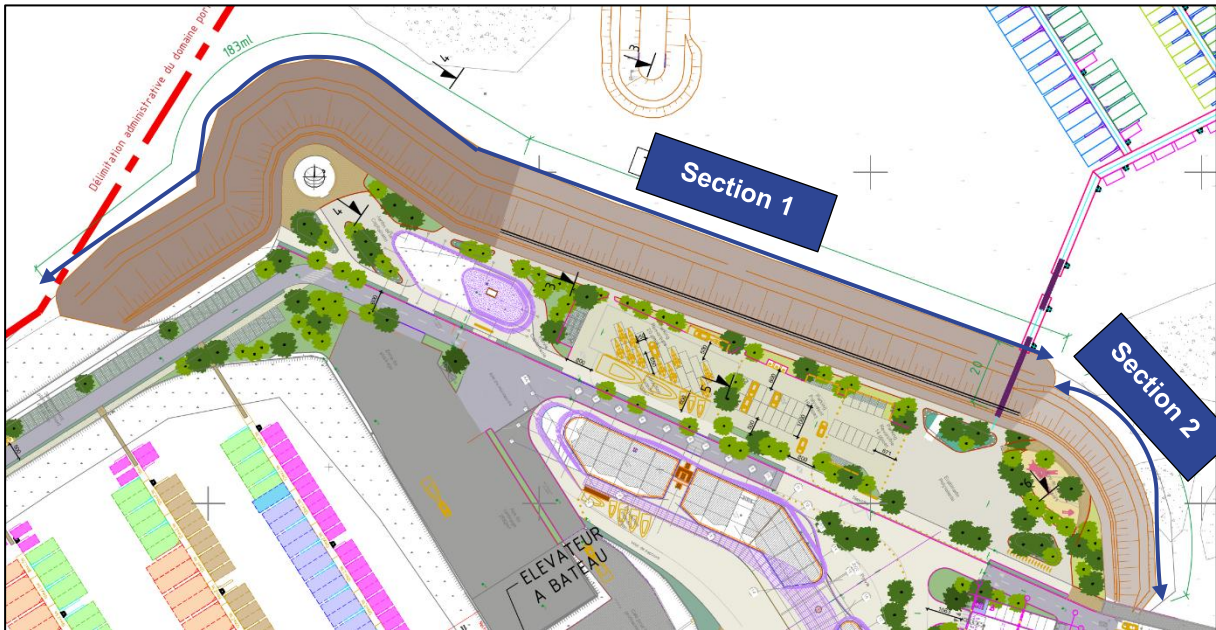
Localisation des sections d'ancrage de la butée de pied du remblai du terre-plein central
